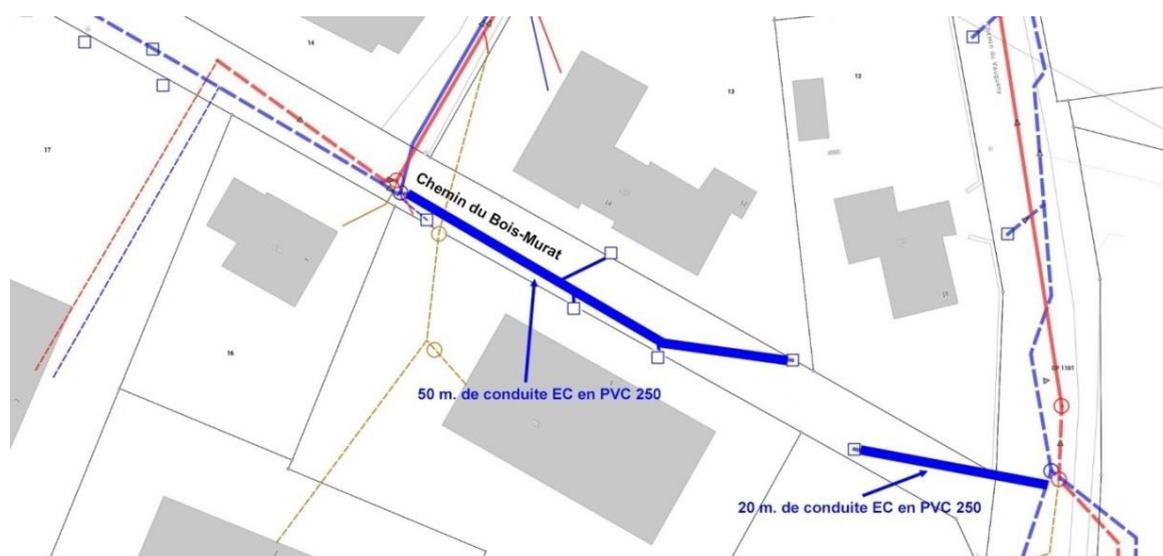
Plan des travaux au niveau du Ch. de Bois-Murat
